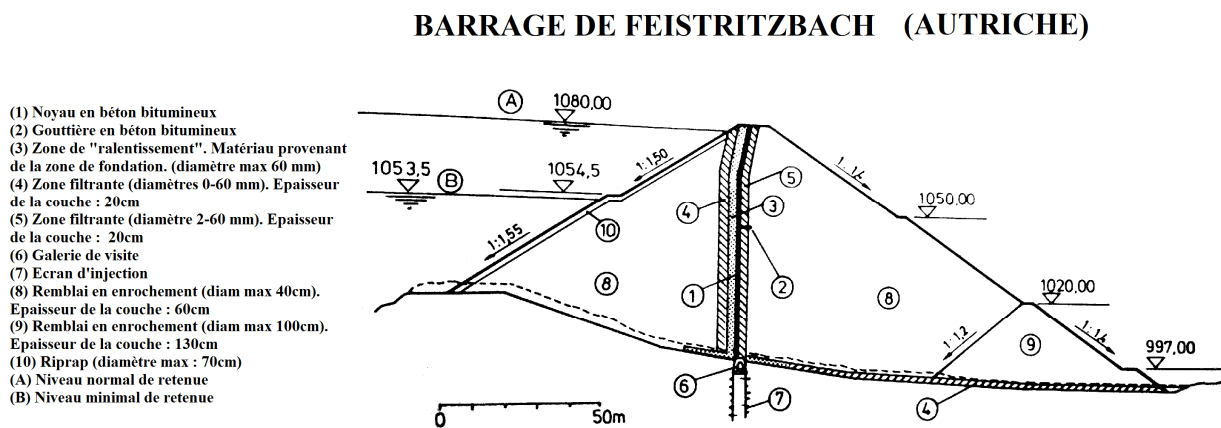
coupe transversale du barrage de Feistritzbach
